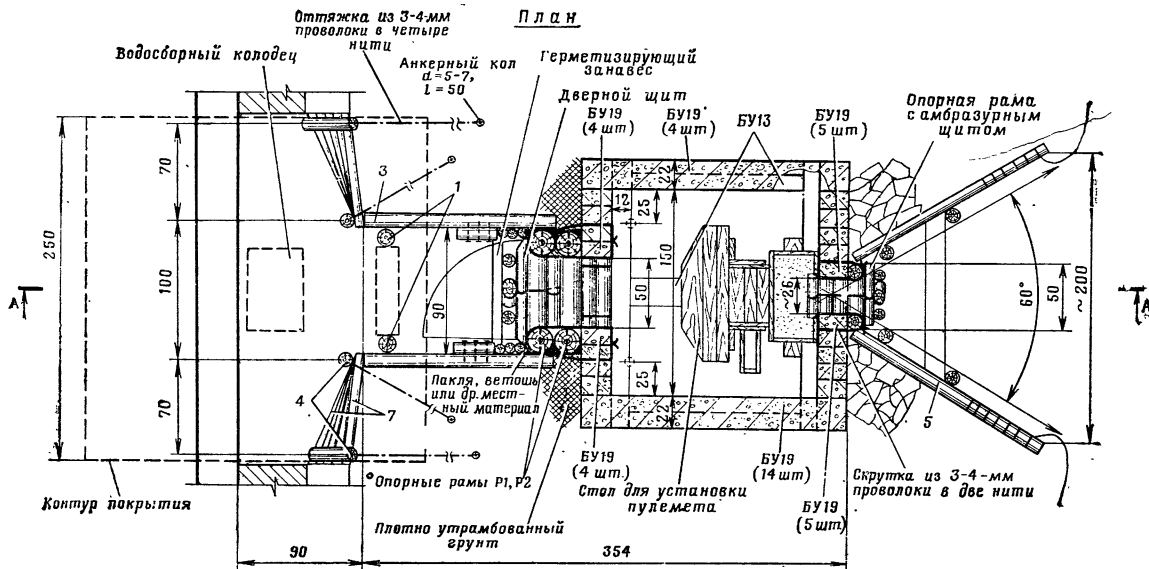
Сборное пулеметное сооружение из железобетонных перемычек
